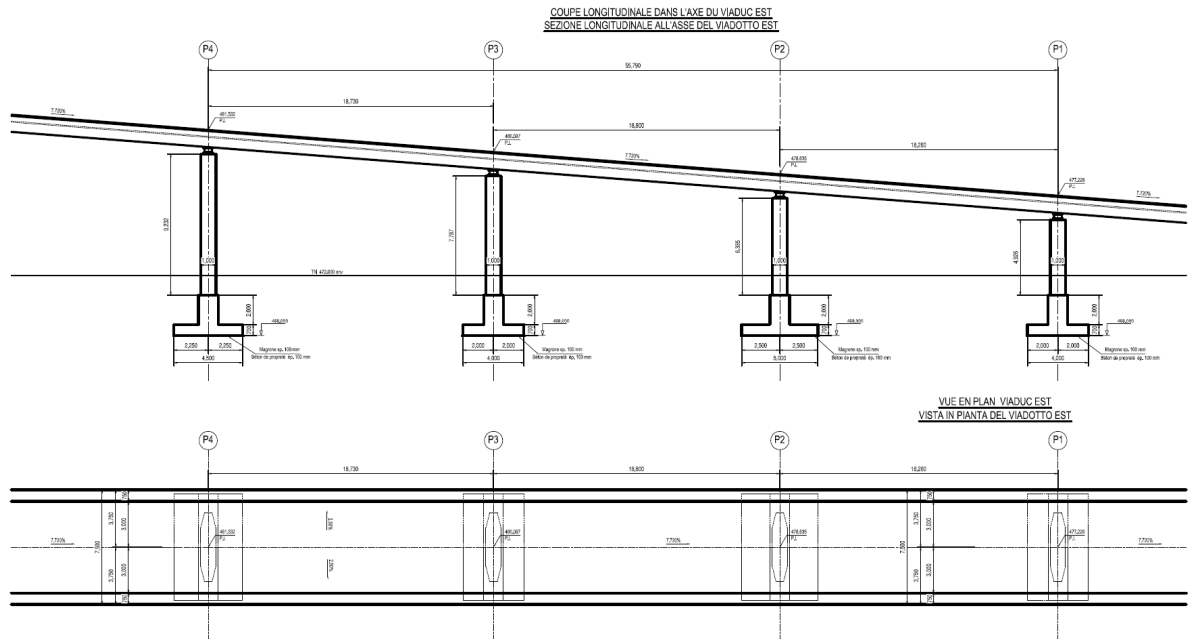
pile lato est (P1, P2, P3 e P4) – sezione longitudinale e pianta.
